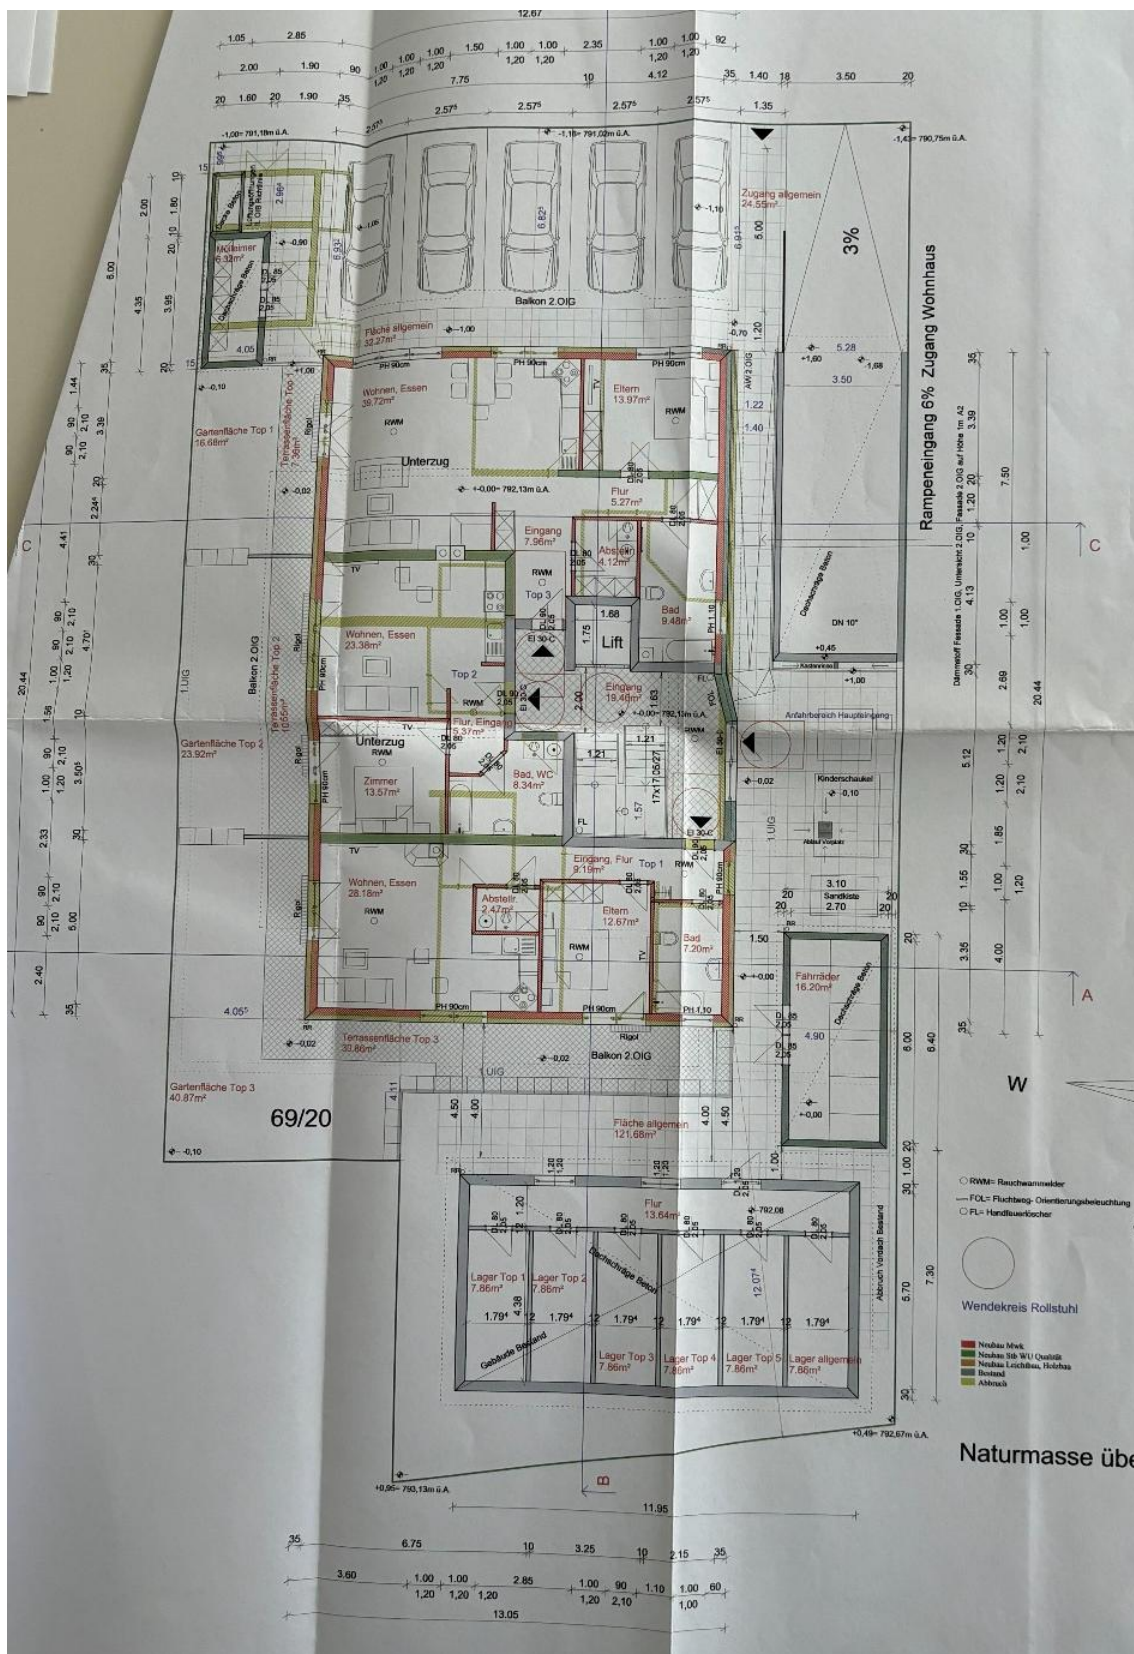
Grundriss Erdgeschoss (Einreichplan, v. 14.4.2014)¹³
